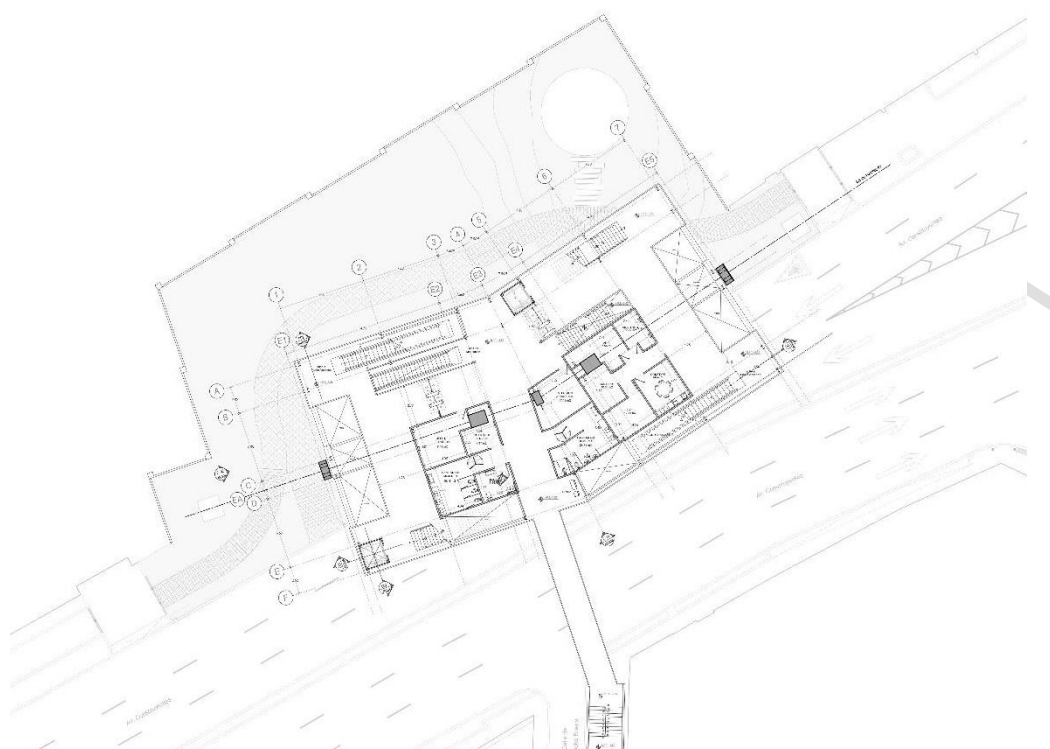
Planta Mezzanine Estación Lienzo Charro
